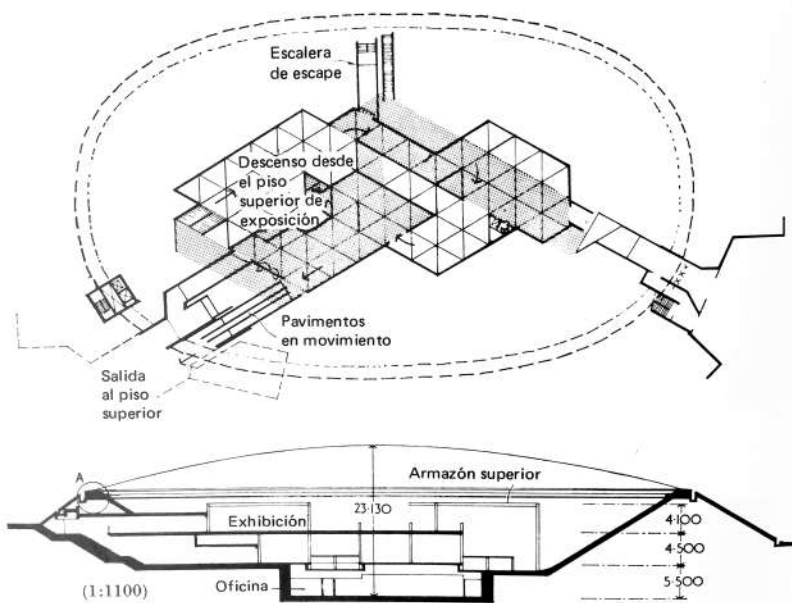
Planta y sección del pabellón de los Estados Unidos.
